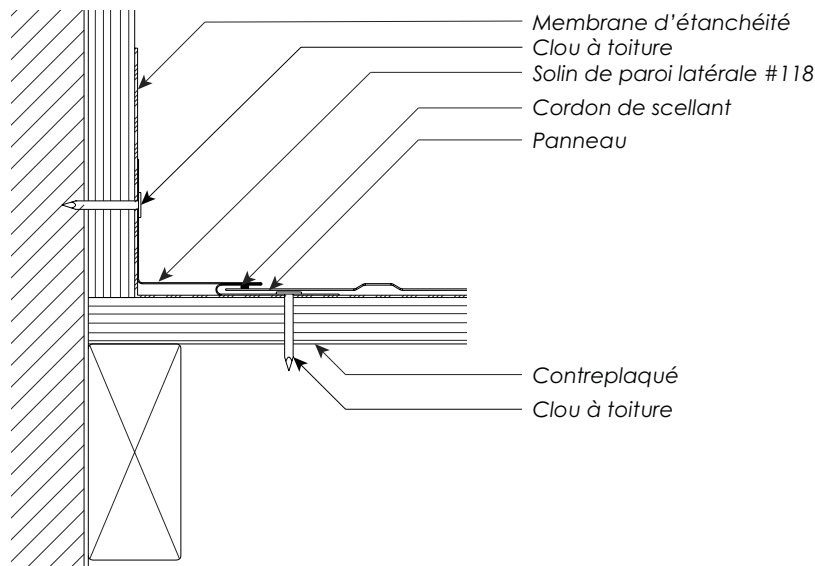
a | Vue en coupe du solin de paroi latérale – méthode 1
